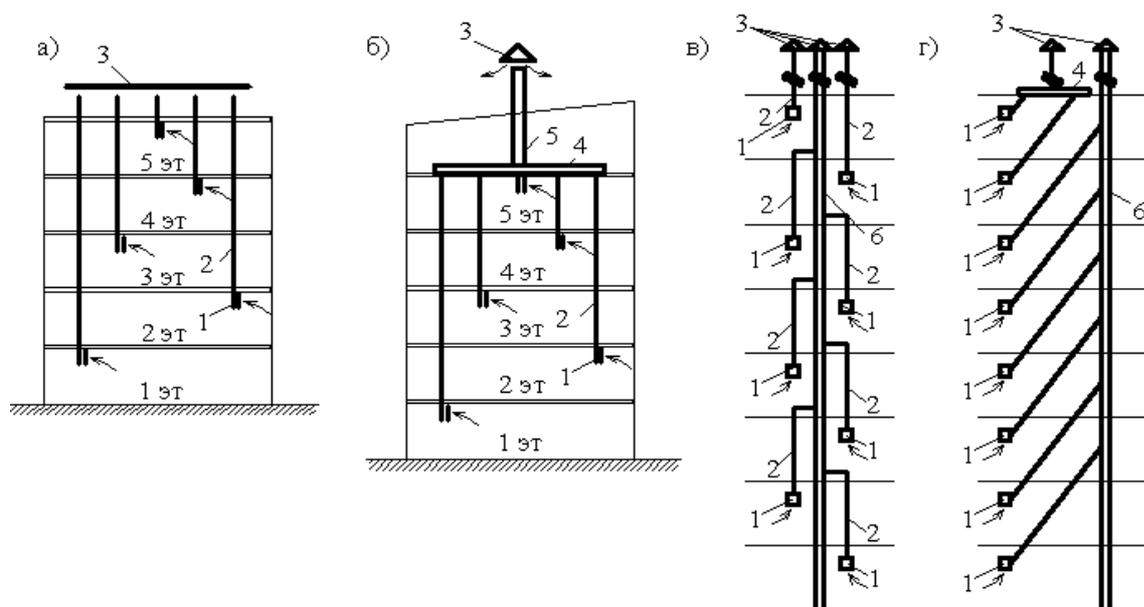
Схема вытяжных каналов жилых зданий: а – отдельные каналы;
